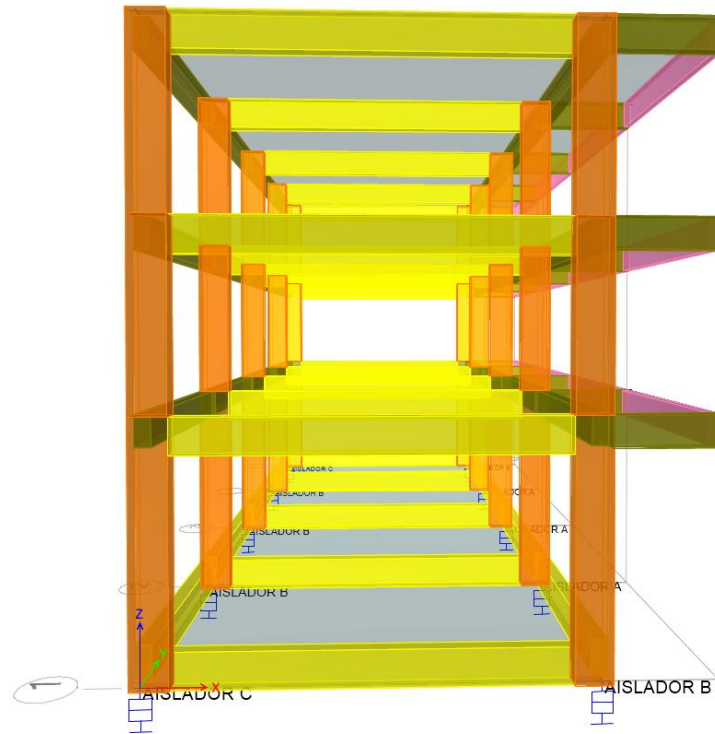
k. Vista tridimensional lateral sistema aislado.
